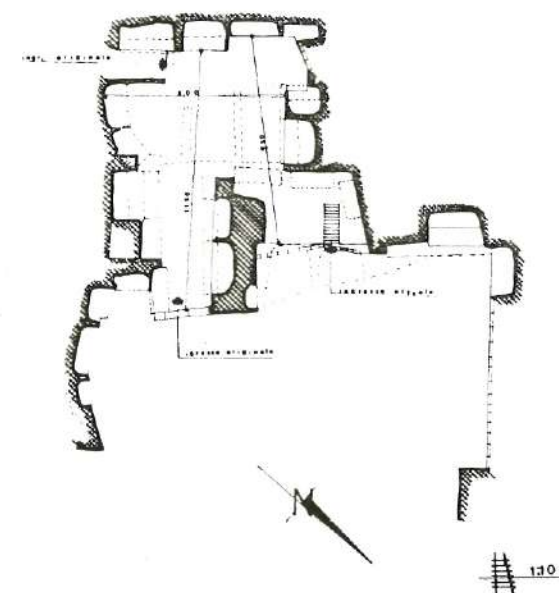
CAPPARELLI: planimetria dell'ipogeo n. 4.
